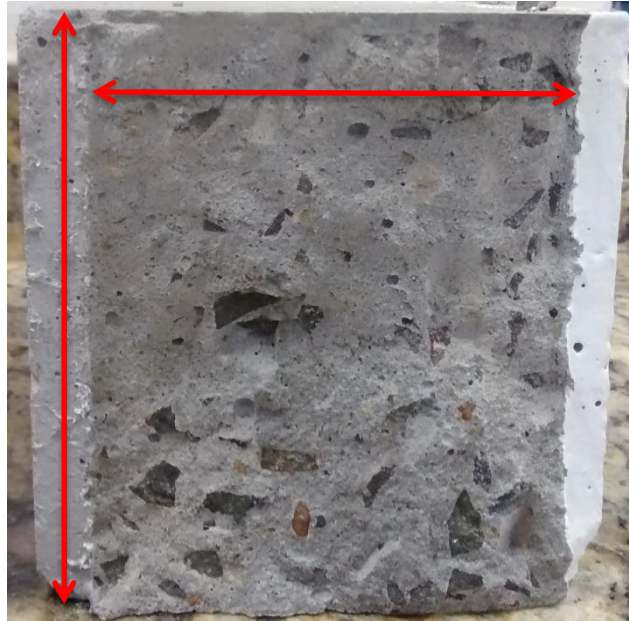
Área da interface concreto-concreto da peça cisalhada
